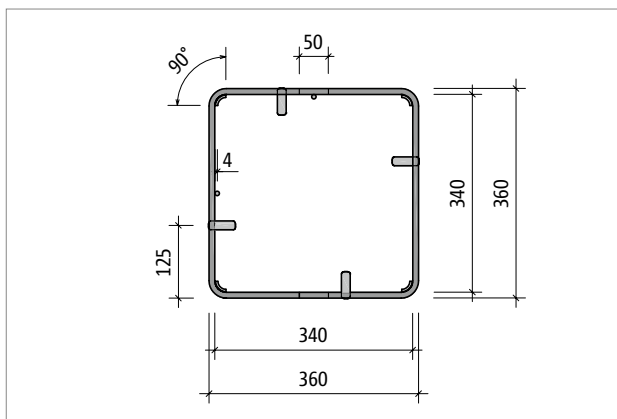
Schöck Scconnex® Typ P-B400: Part T; geschweisste Bügel und Biegeformsegmente aus Edelstahl
